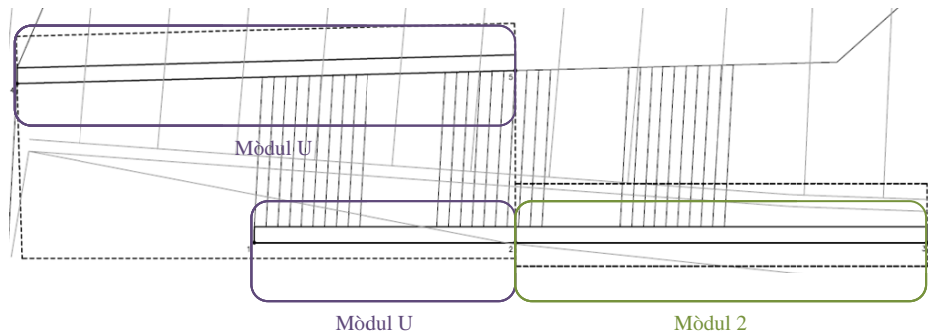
Plànol núm.18.1 full 5 Mur 4 planta.
